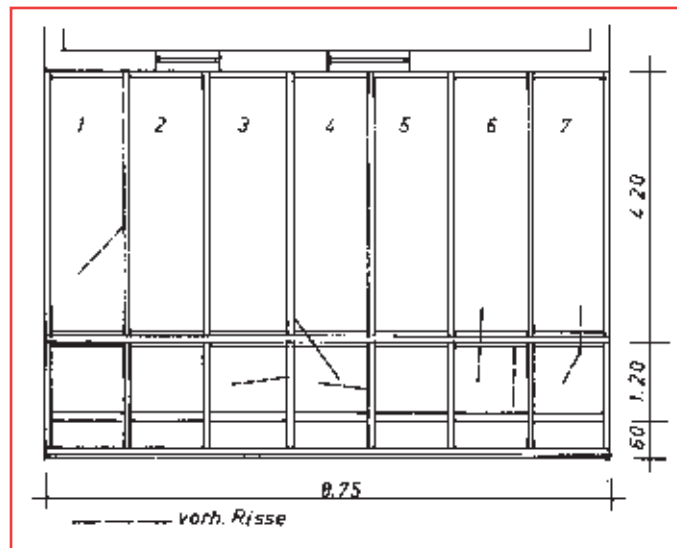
Draufsicht des Wintergartens mit Darstellung der vorhandenen Risse
